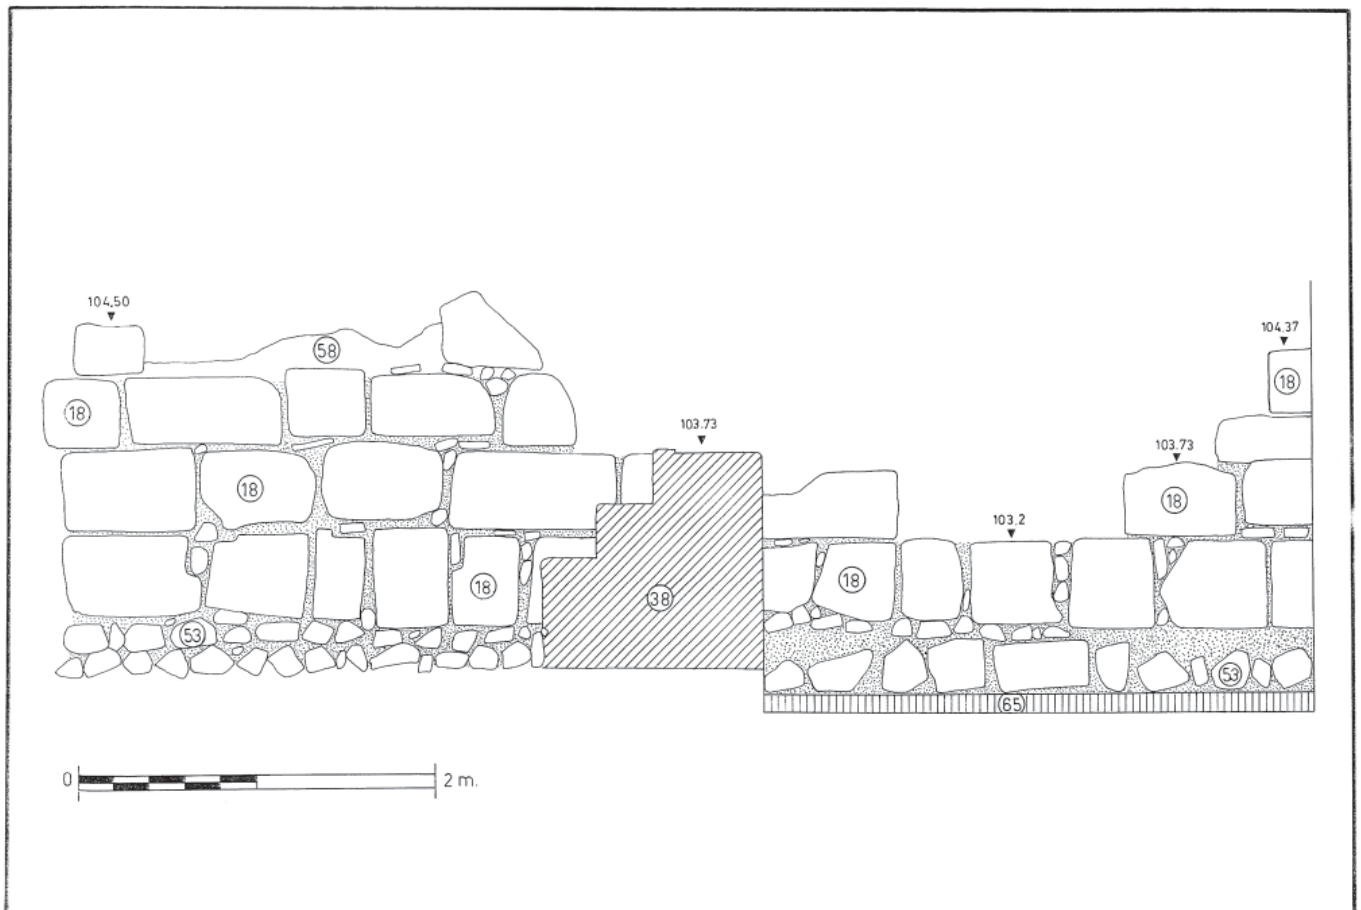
Corte 2. Alzado S. del muro U.E. 18.
